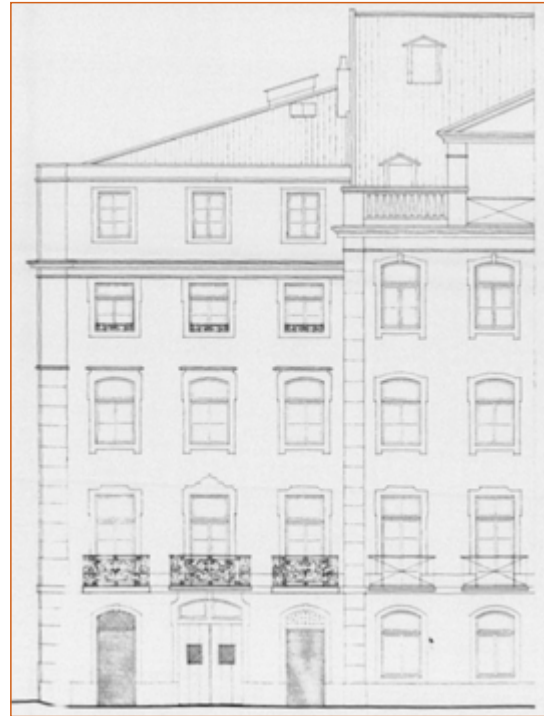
Alçado da fachada do prédio de esquina sobre o largo do Carmo e travessa do Carmo. Desenho gentilmente cedido pela Fundação AJB - A Junção do Bem.
